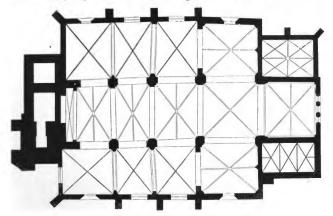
Stephanikirche, Grundrifs vor dem Umbau.
